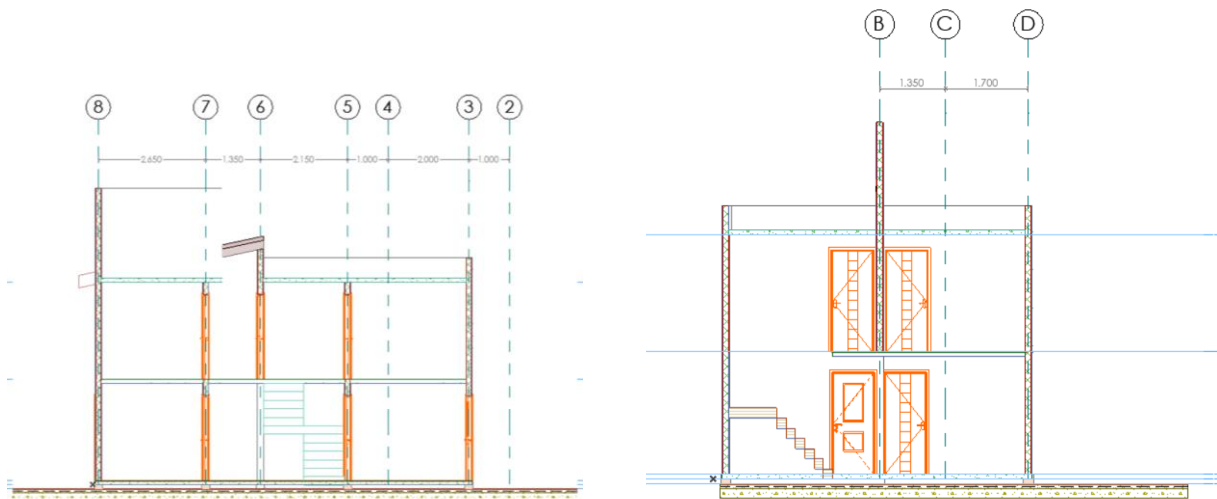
Corte 1 longitudinal y corte 2 transversal
